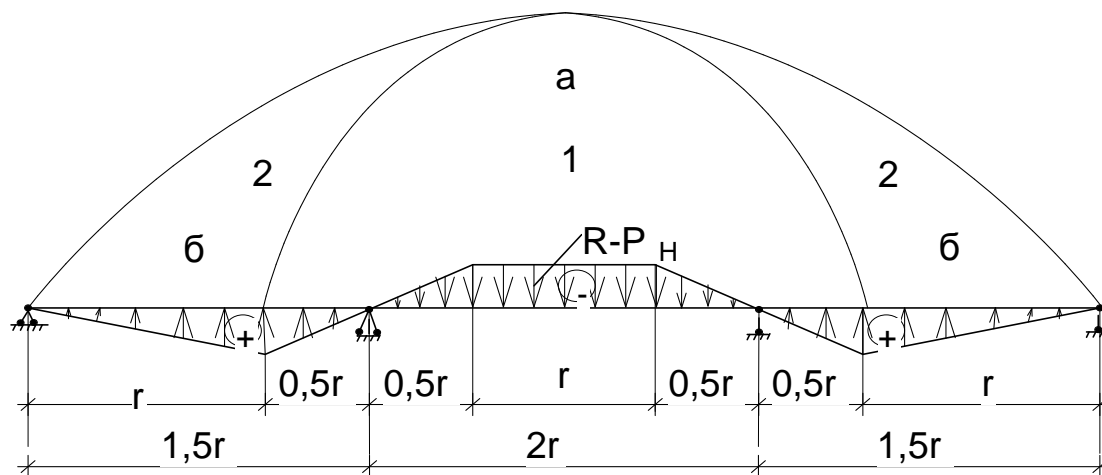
Эпюра равновесия реактивных сил. Статическая схема: 1 – параболический свод нагрузки от стены на фундамент; 2 – параболический свод деформаций в кладке стены; а – зона сильных деформаций и повреждений кладки стены; б – зона средних и слабых деформаций кладки стены
